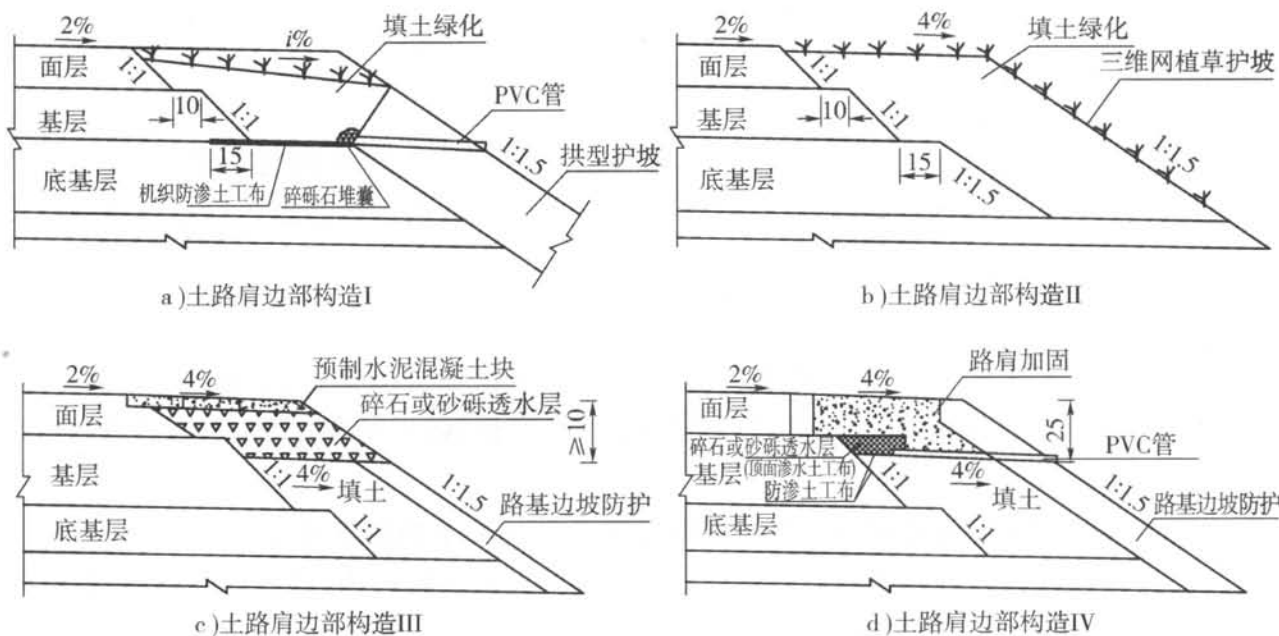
分散排水路肩构造图(尺寸单位:cm)
